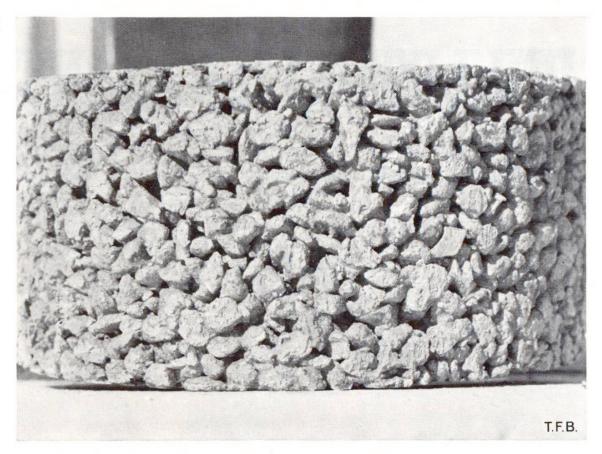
Structure d'un béton filtrant en matériaux concassés env. 10-20 mm.
